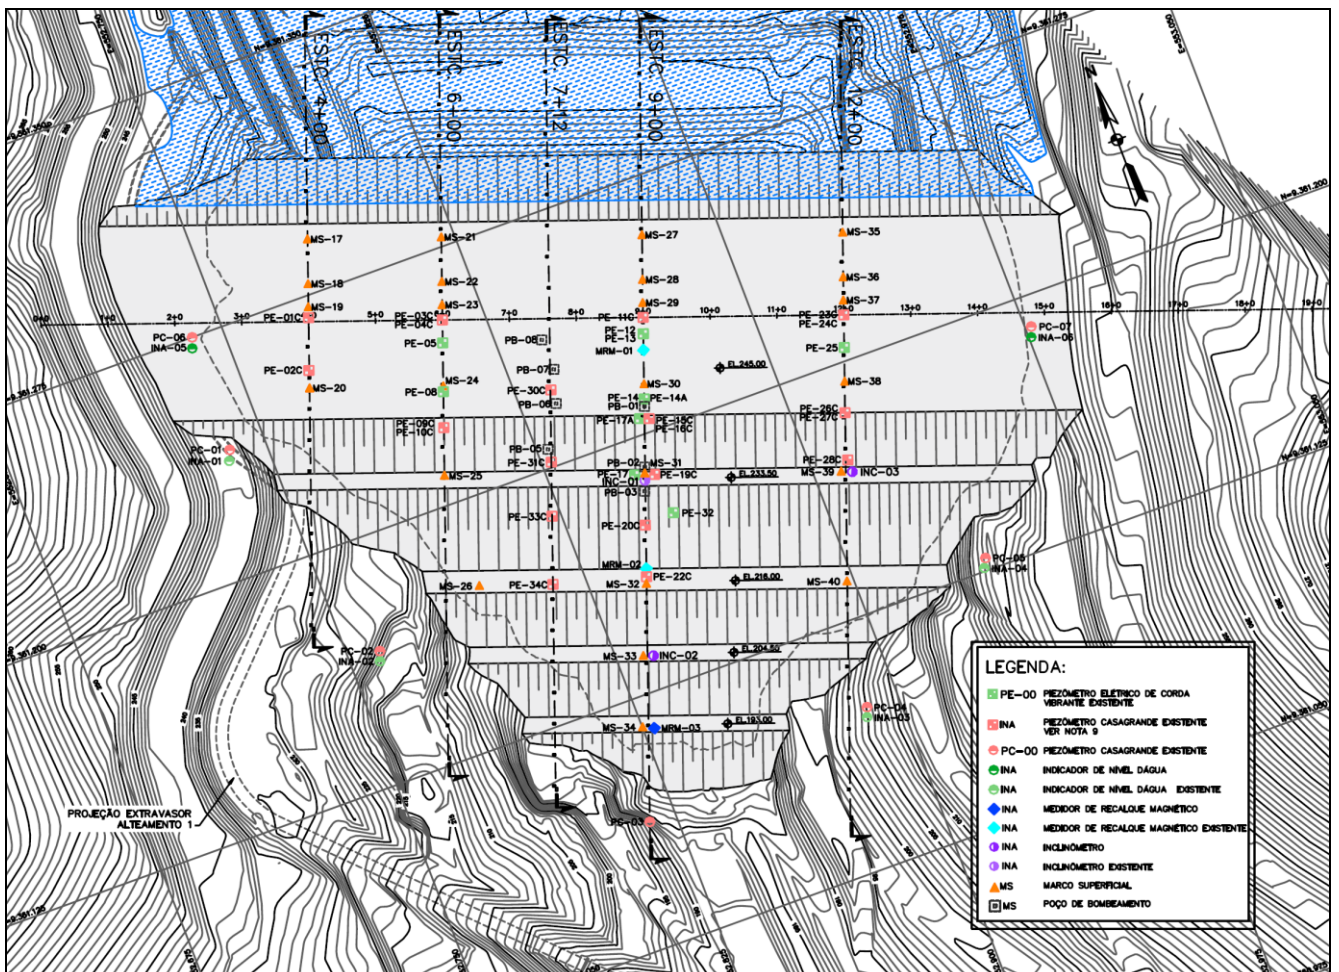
Plano de instrumentação (9002SA-X-70526)
